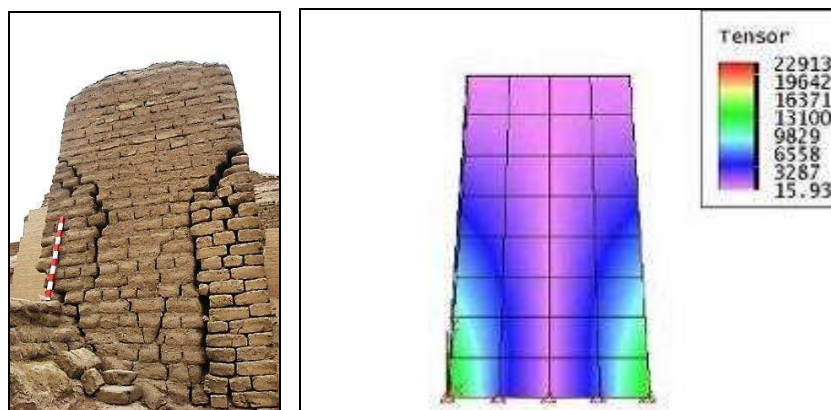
Muro de sección trapezoidal y modelo matemático que interpreta su comportamiento estructural bajo cargas dinámicas, los agrietamientos se forman con un esfuerzo de $0,13 \text{ kg/cm}^2$.
